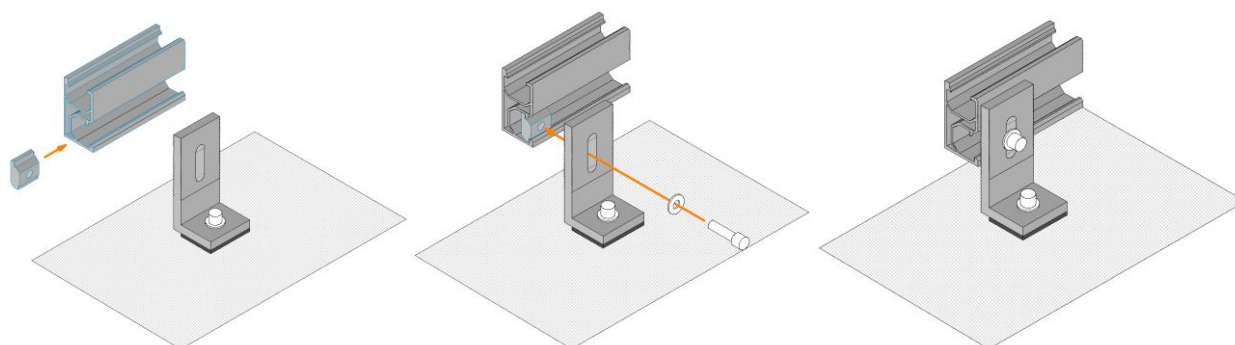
Соединение монтажного профиля и L-образного крепления.
